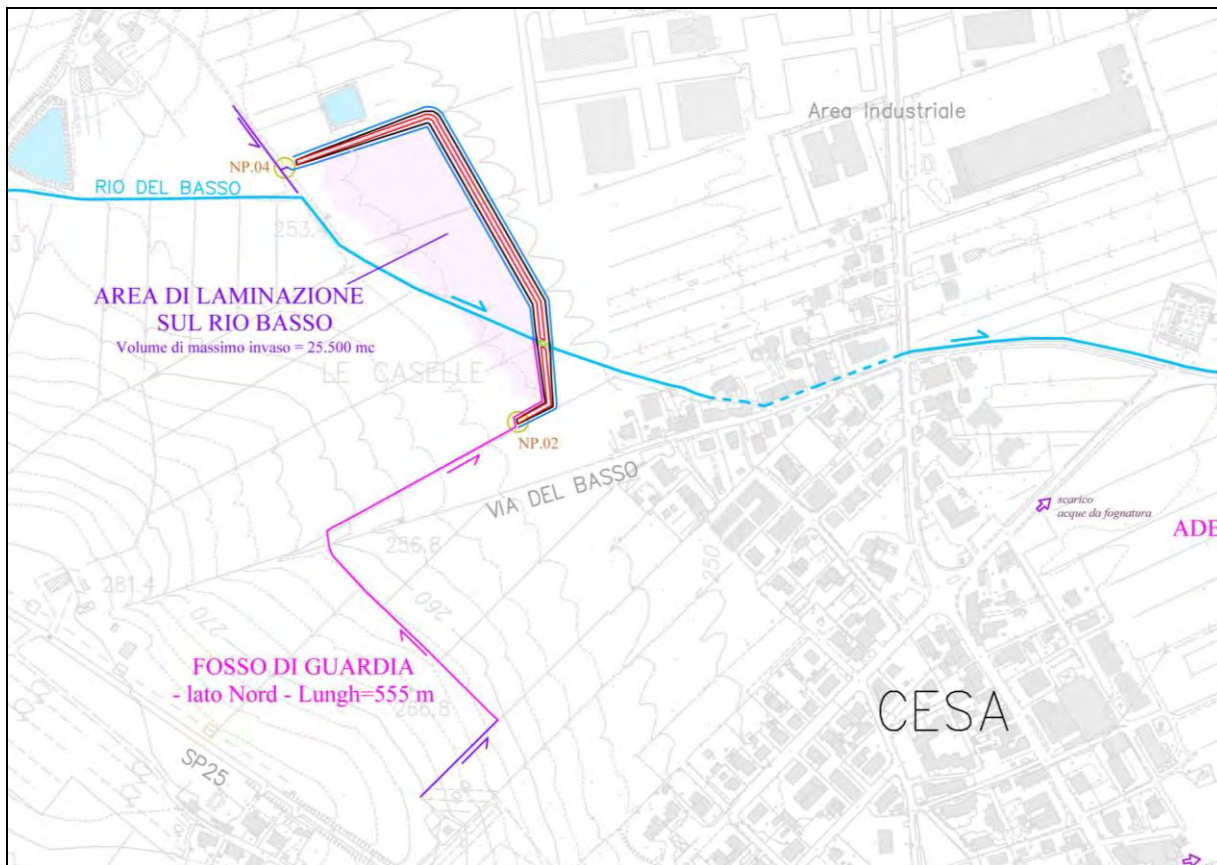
Stato di progetto: planimetria generale opere su Rio Basso
